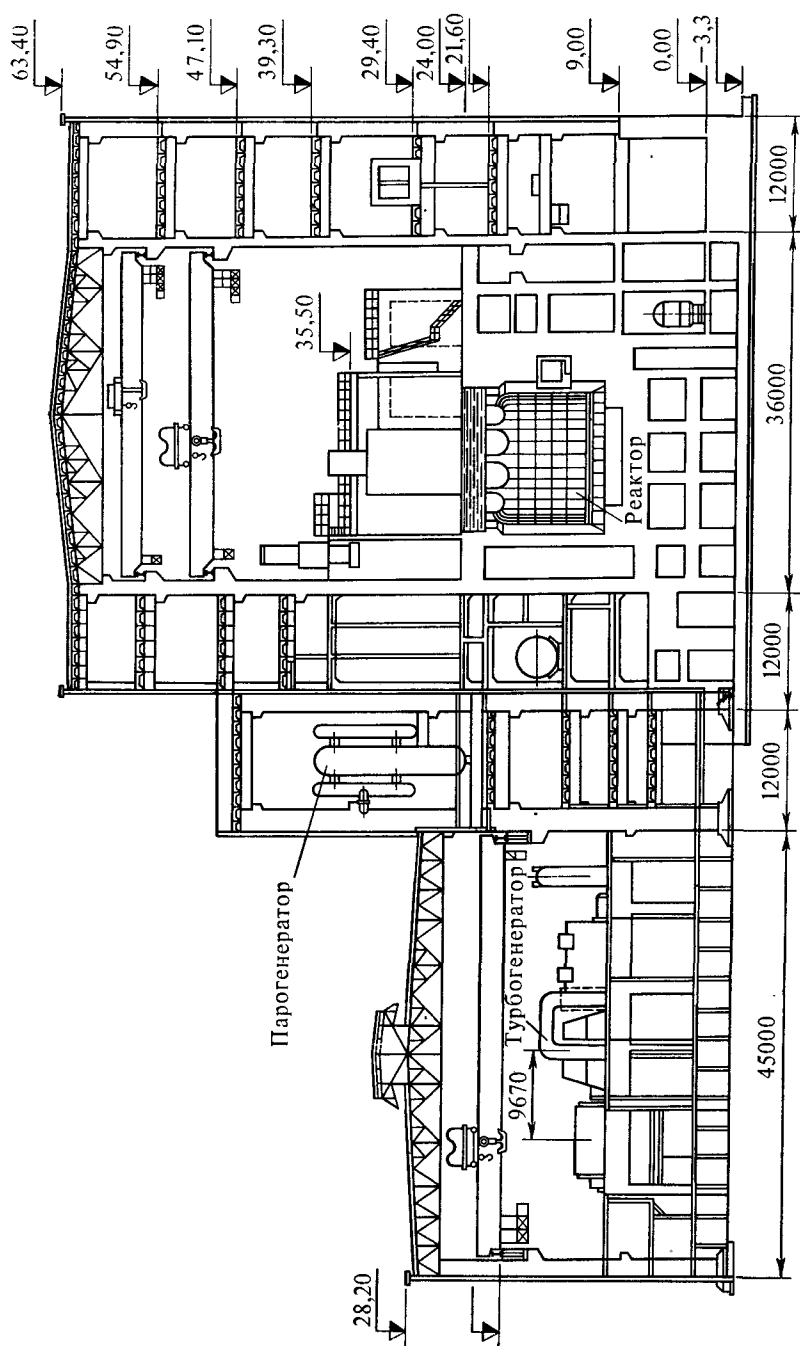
Компоновка главного корпуса АЭС с реактором БН-600 (продольный разрез)
